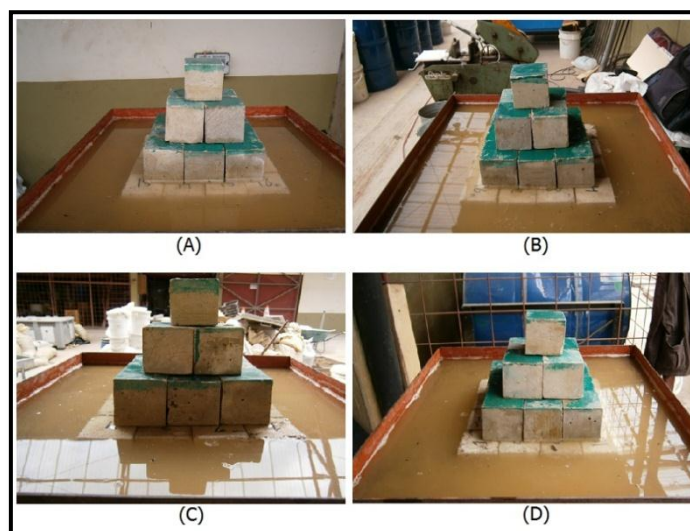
Resultado del modelo a escala combinación 30/70. (A) Fachada norte, (B) fachada este, (C) fachada sur, (D) fachada oeste
